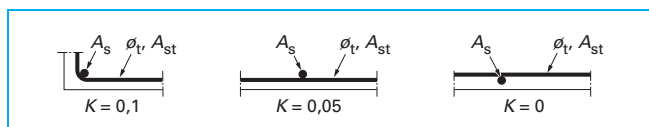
Valeurs de K pour les poutres et les dalles (figure 8.4 de l'EC2)
